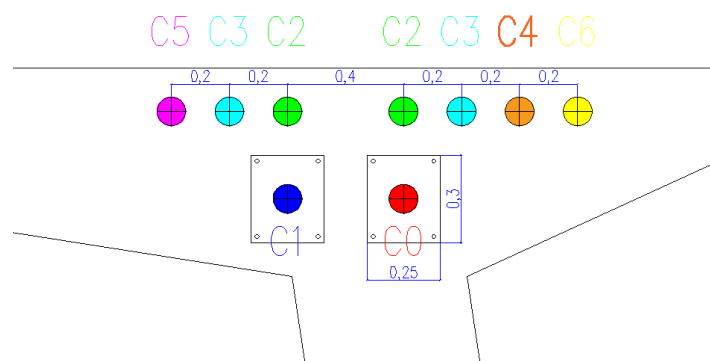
Disposition des câbles et ancrages de fléau
